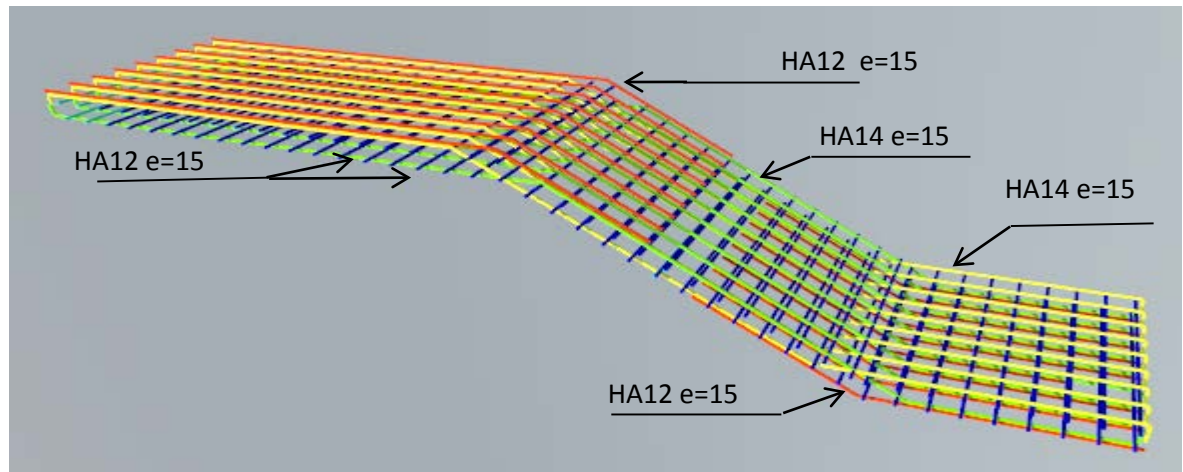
Ferrailage escaliers Volée I en 3D.
